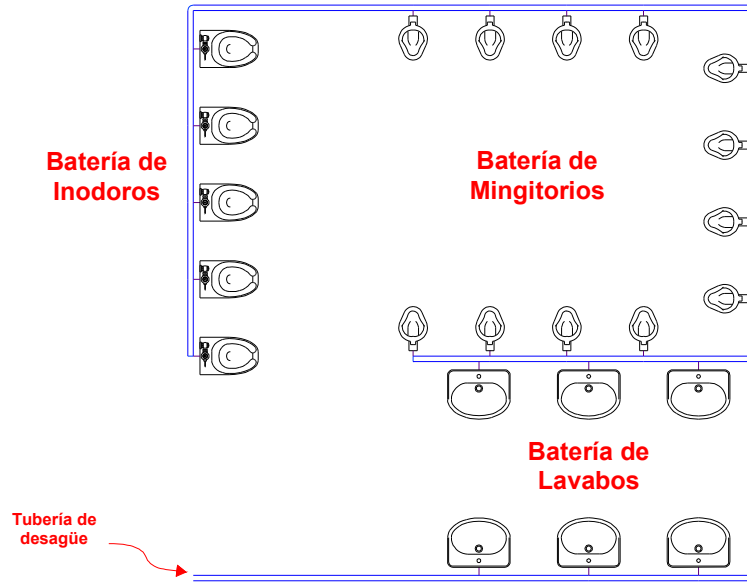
Conjunto de baterías de muebles de baño
